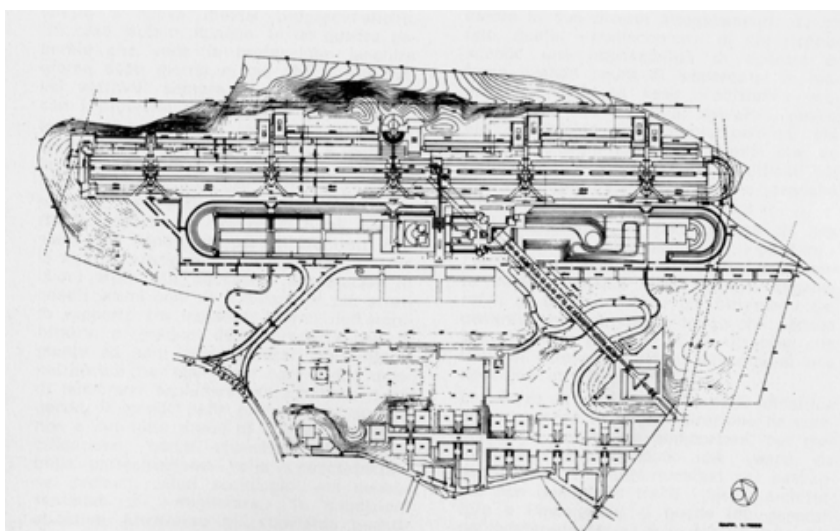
| La planimetria del Piano di Zona 61, detto Corviale.
